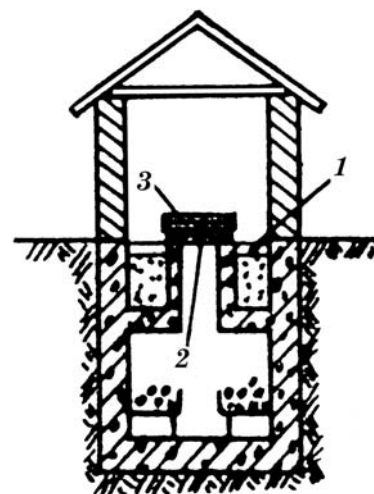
Погреб, совмещенный с гаражом: 1 – лаз; 2 – круглая стальная сварная решетка; 3 – одеяло.
